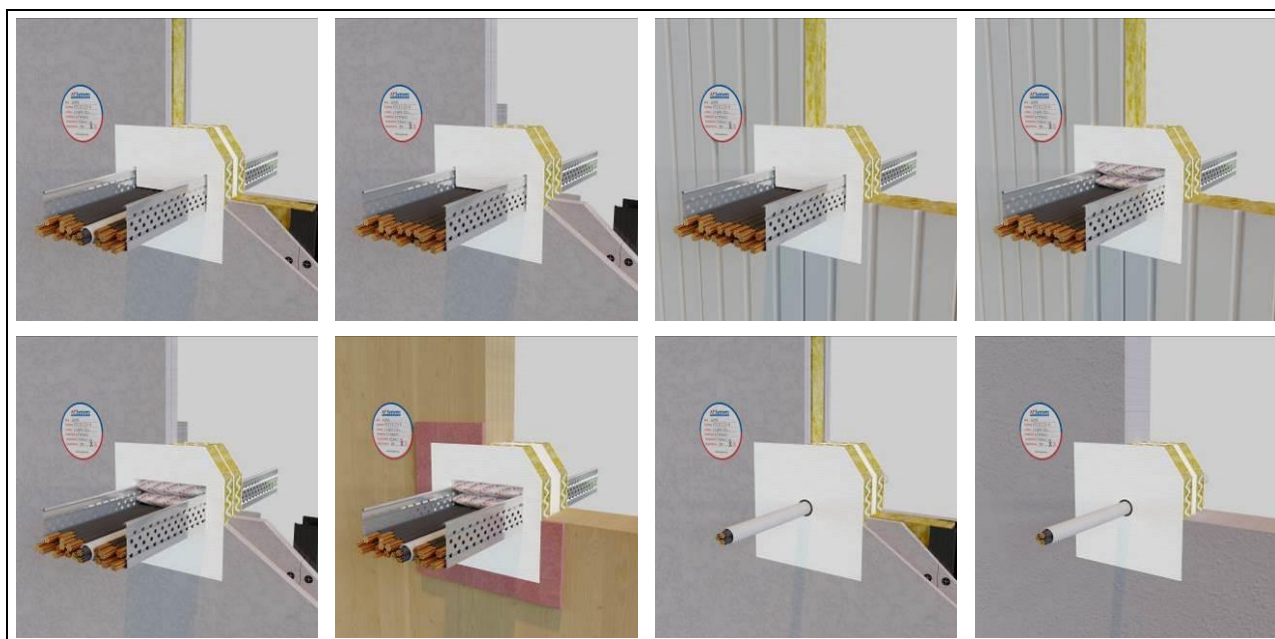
Ejemplo de sellado de cables eléctricos en paredes.
